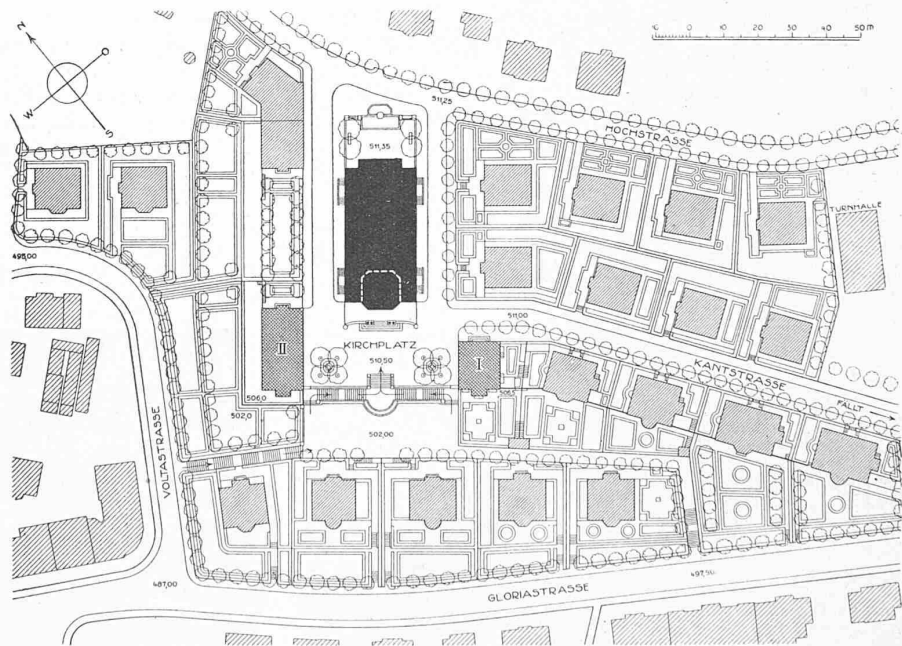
Lageplan der Kirche samt Umgebung; I Pfarrhaus, II Vorgesehenes Kirchgemeindehaus. — 1:2000.
